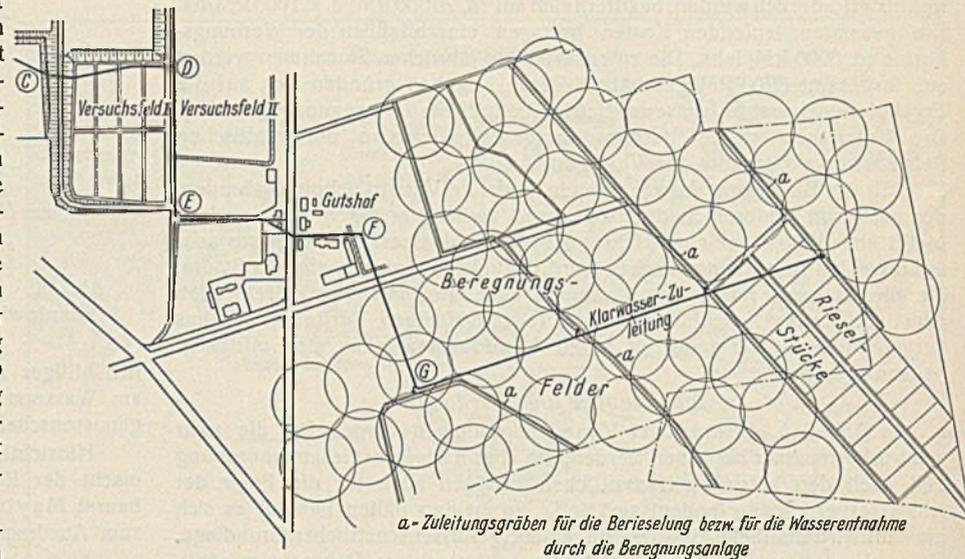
Berliner Klarwasser-Verregnungsanlage Stahnsdorf. Lageplan. Größe 25 ha.
